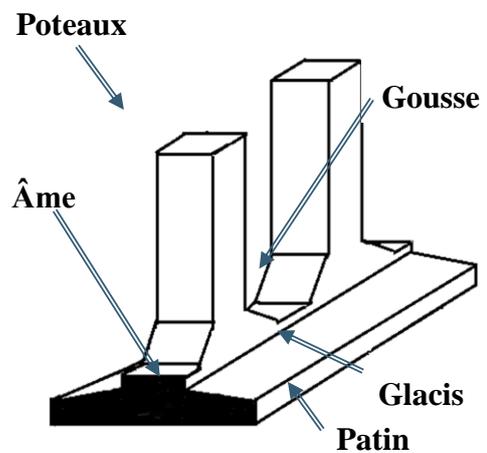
semelles filante placée sous plusieurs poteaux rapprochés
